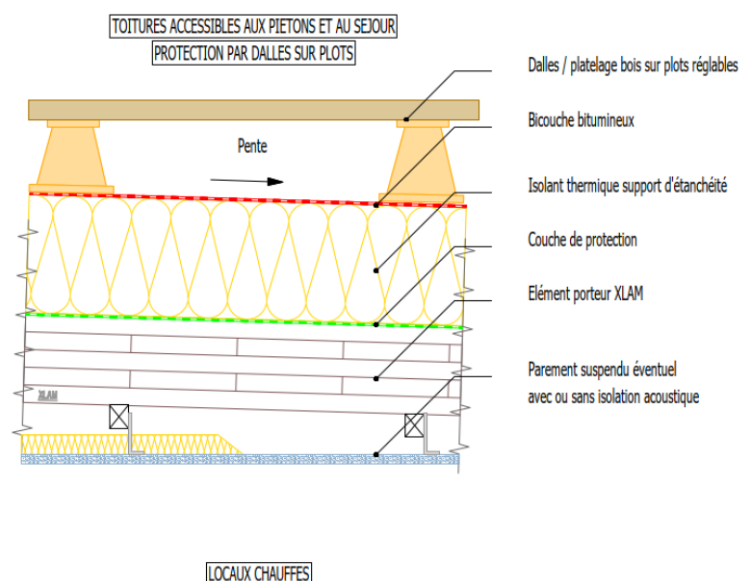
Composition Toiture isolée - Accessible aux piétons et au séjour
